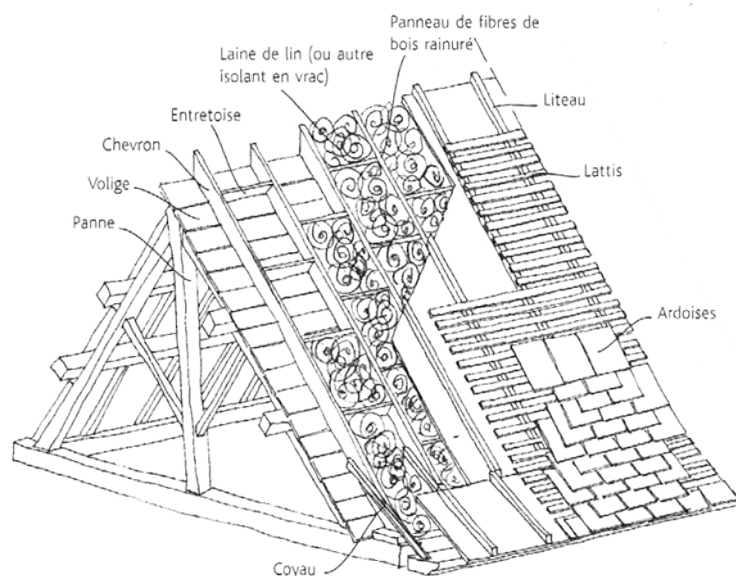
Isolation d'une toiture par caissons extérieurs remplis d'isolant (source : Le Goarnig, 2008)
